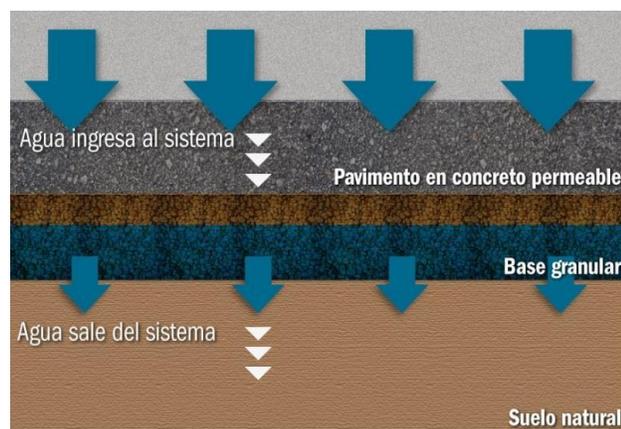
Ilustración tomada de 360 en concreto Argos.
